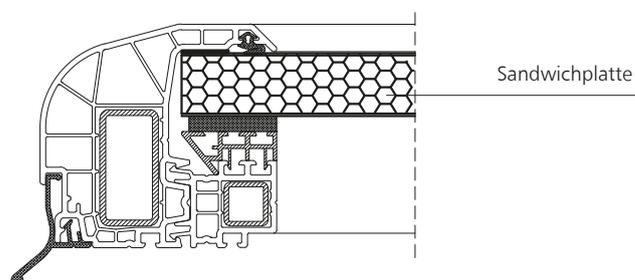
Schnitt durch den Öffnungsflügel, Füllung mit ALU Sandwichplatte
